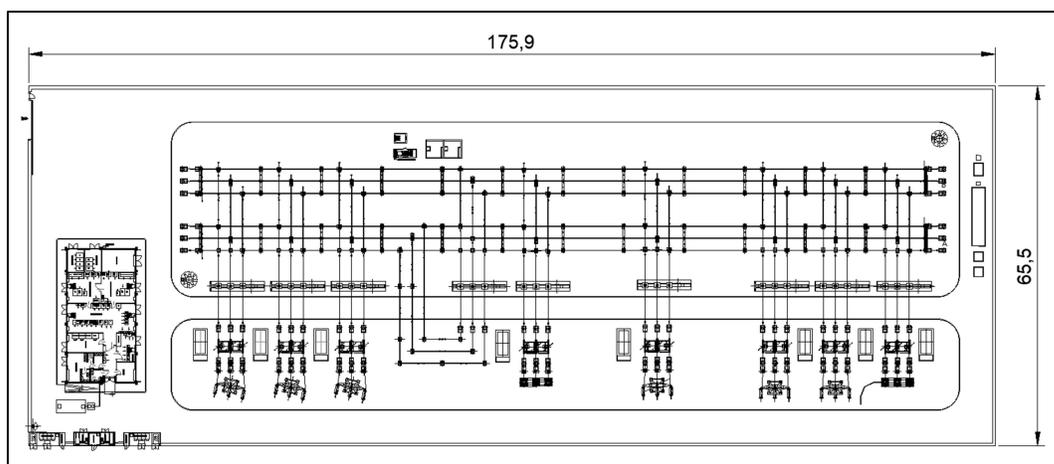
Layout elettromeccanico della nuova SE di smistamento-132 kV
